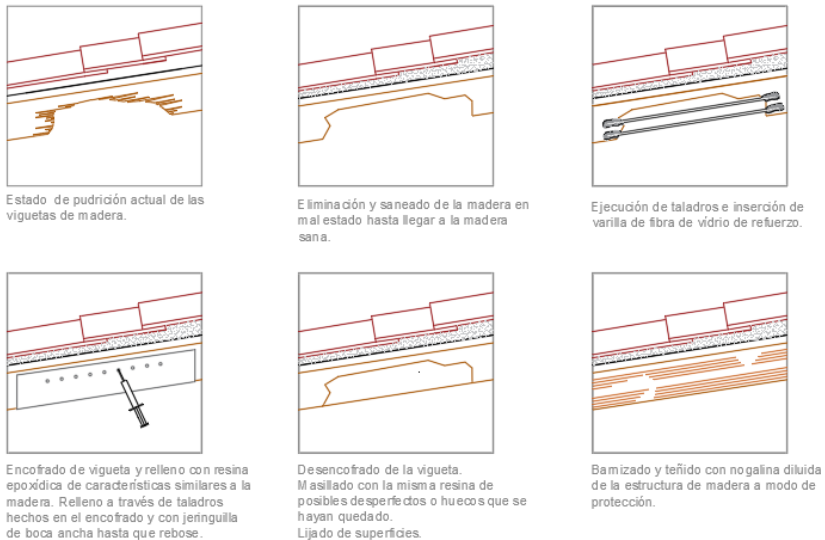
Detalle de reconstrucción de viguetas de madera; Fuente: CAD Propio
